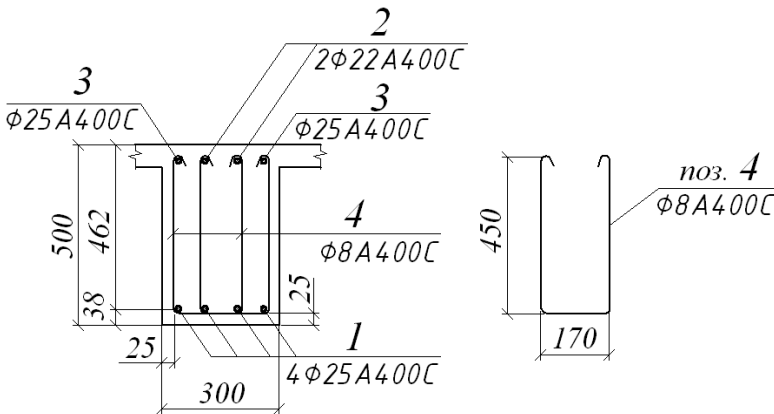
Арматування перерізу балки поперечною вертикальною арматурою: 1, 2, 3 – поздовжня арматура; 4 – поперечна арматура
